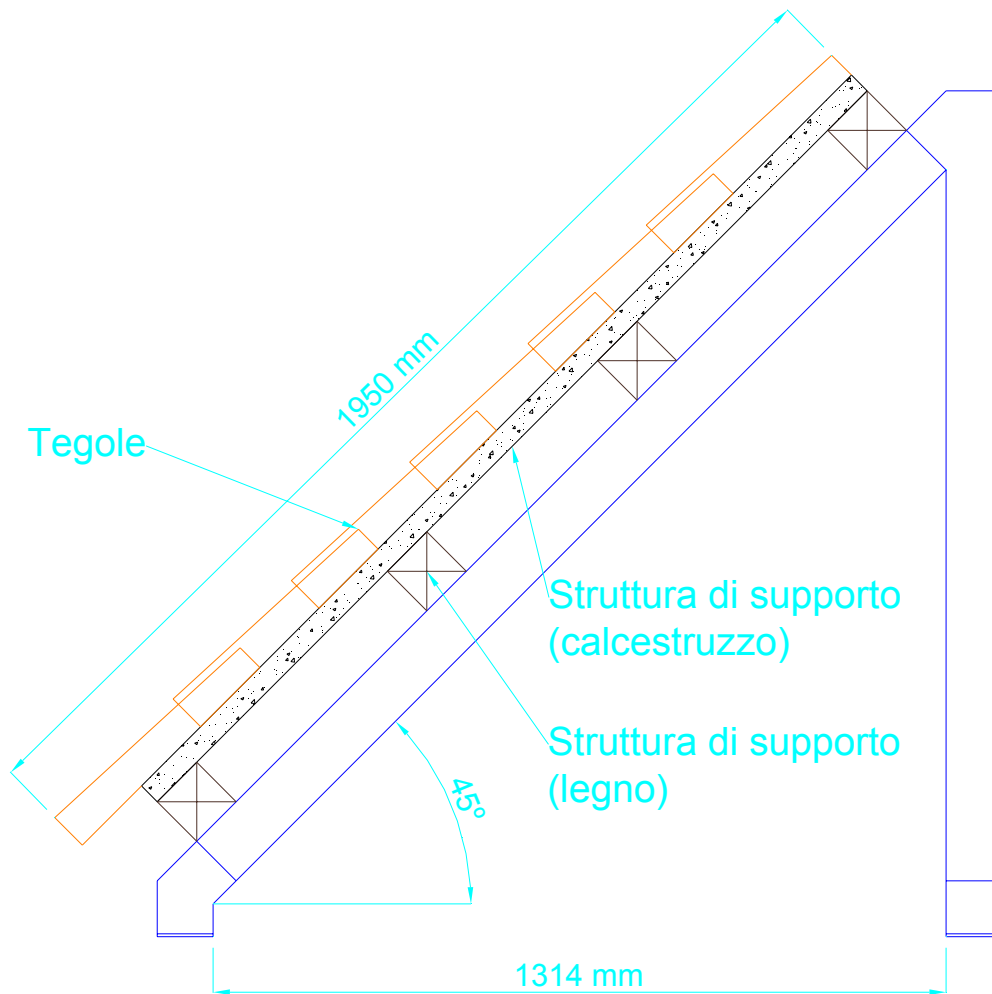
Profilo della struttura di supporto con la disposizione delle tegole
